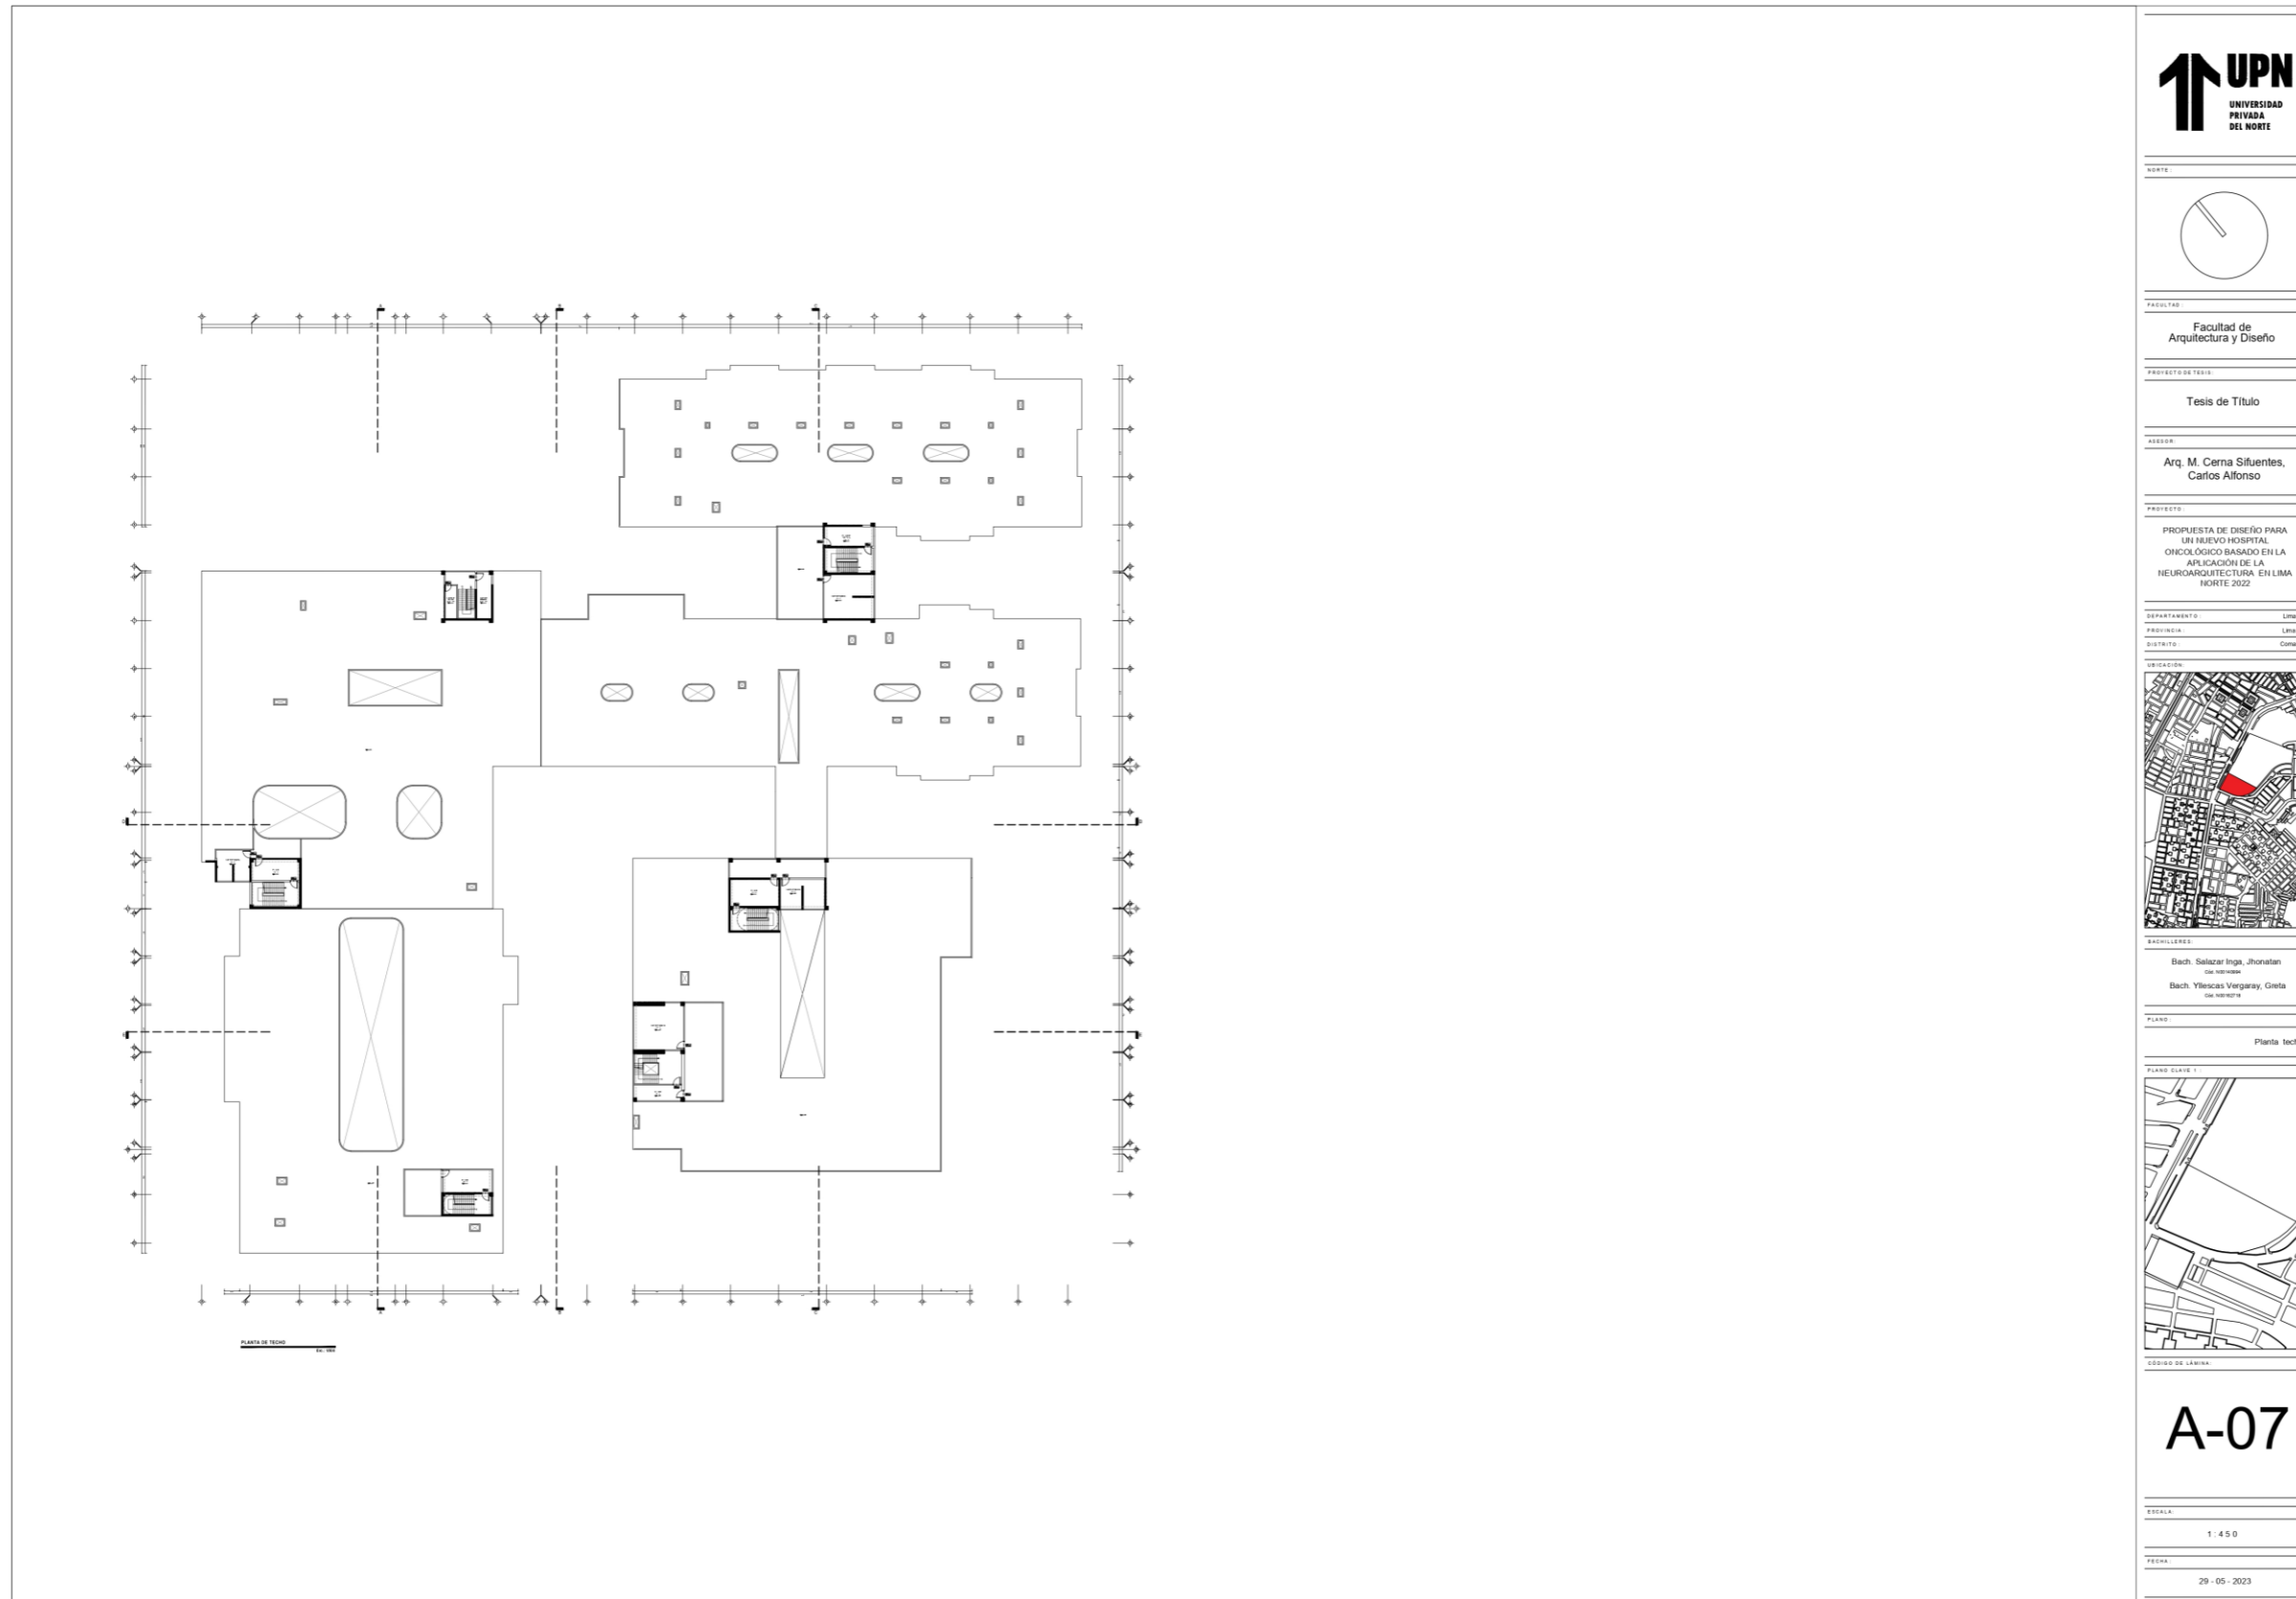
Arquitectura – Planta de techo N°5 Esc: 1/450 (Fuente: Elaboración propia de los coautores)
